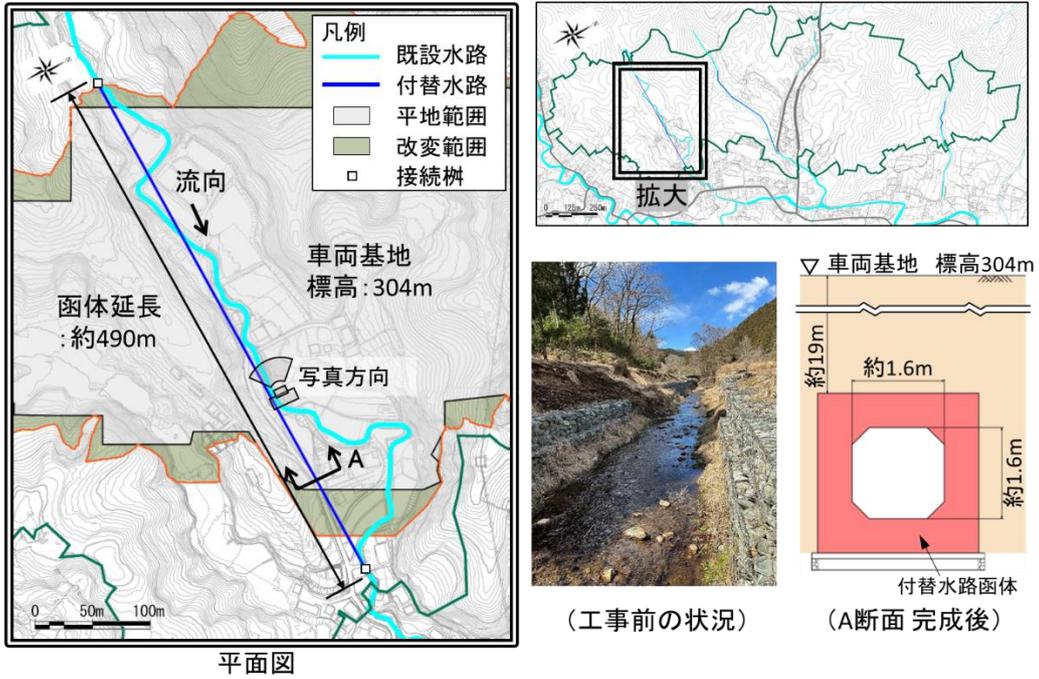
付替水路工 (大沢入沢) の施工概要
